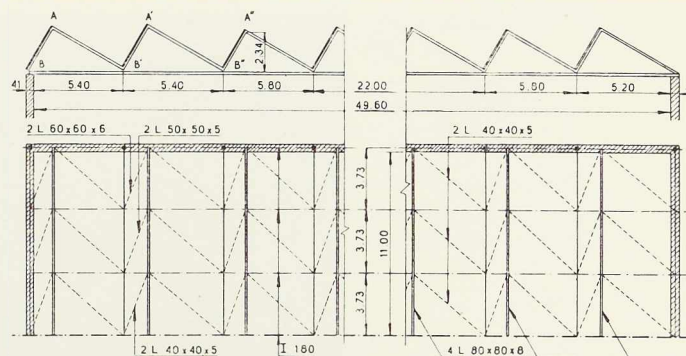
Disposition d'une toiture en shed sans poteaux intermédiaires et sans fermes.
